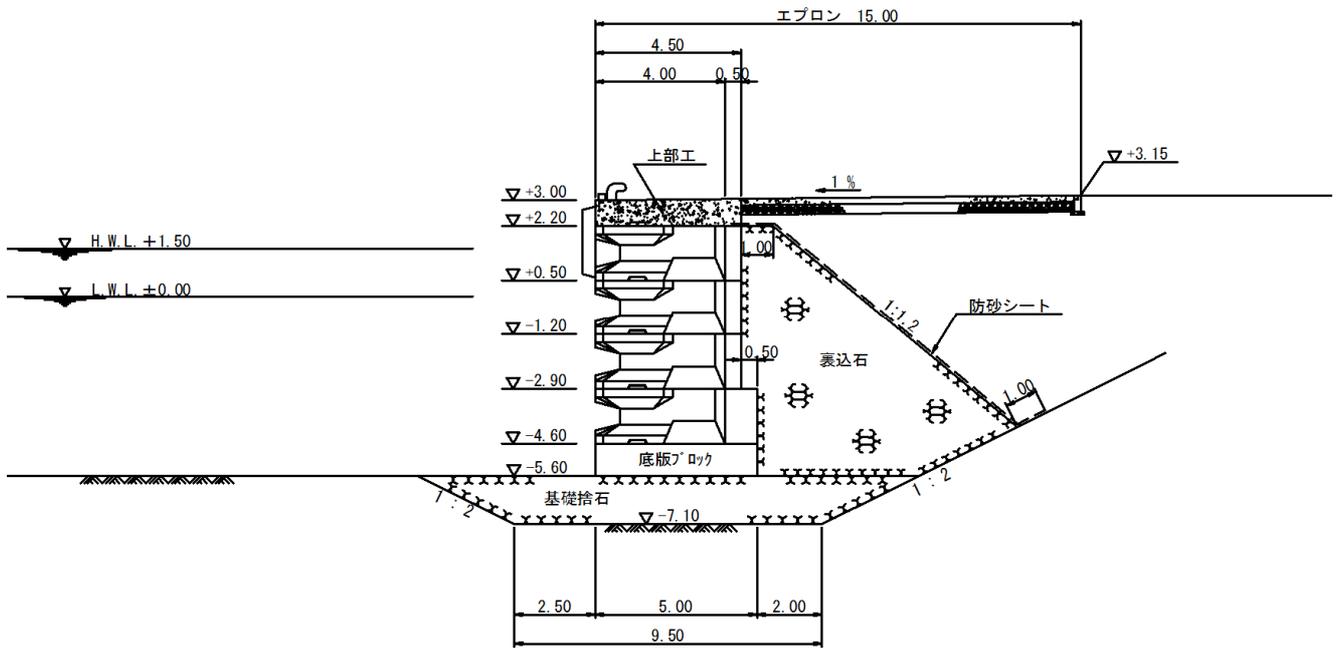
No.22 常陸那珂港区_南埠頭地区 B 岸壁 (-5.5m) の断面図 (被災前)
